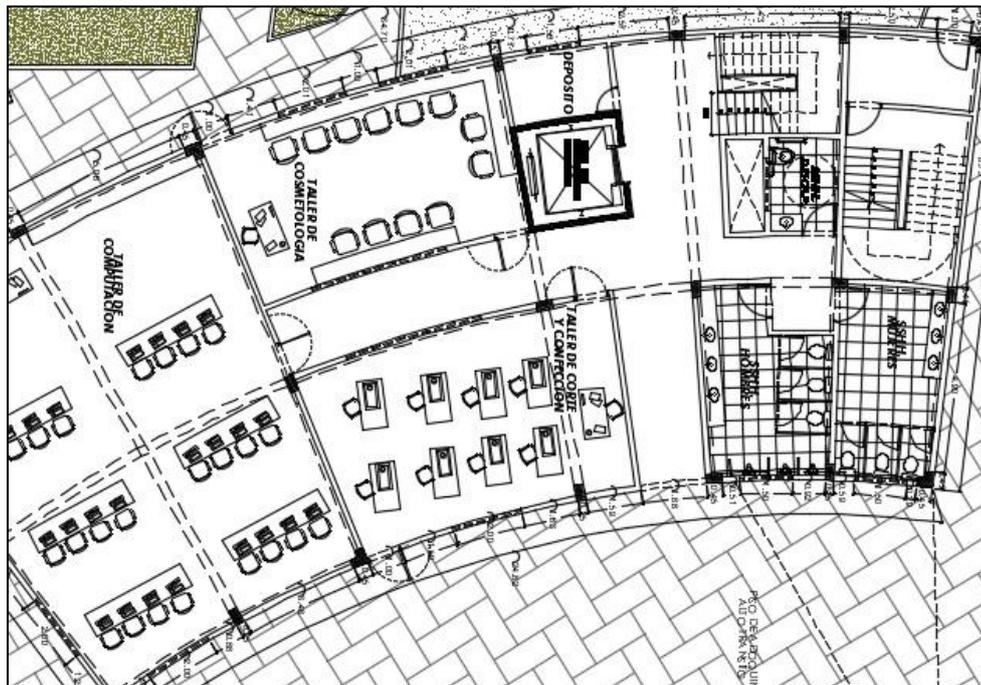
Plano de zona de talleres del proyecto arquitectónico.
